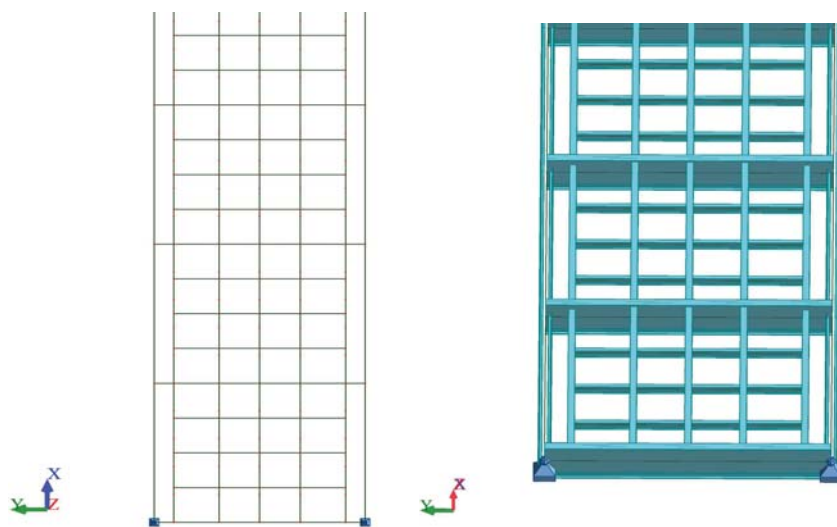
Grelha metálica onde assenta o tabuleiro de betão
